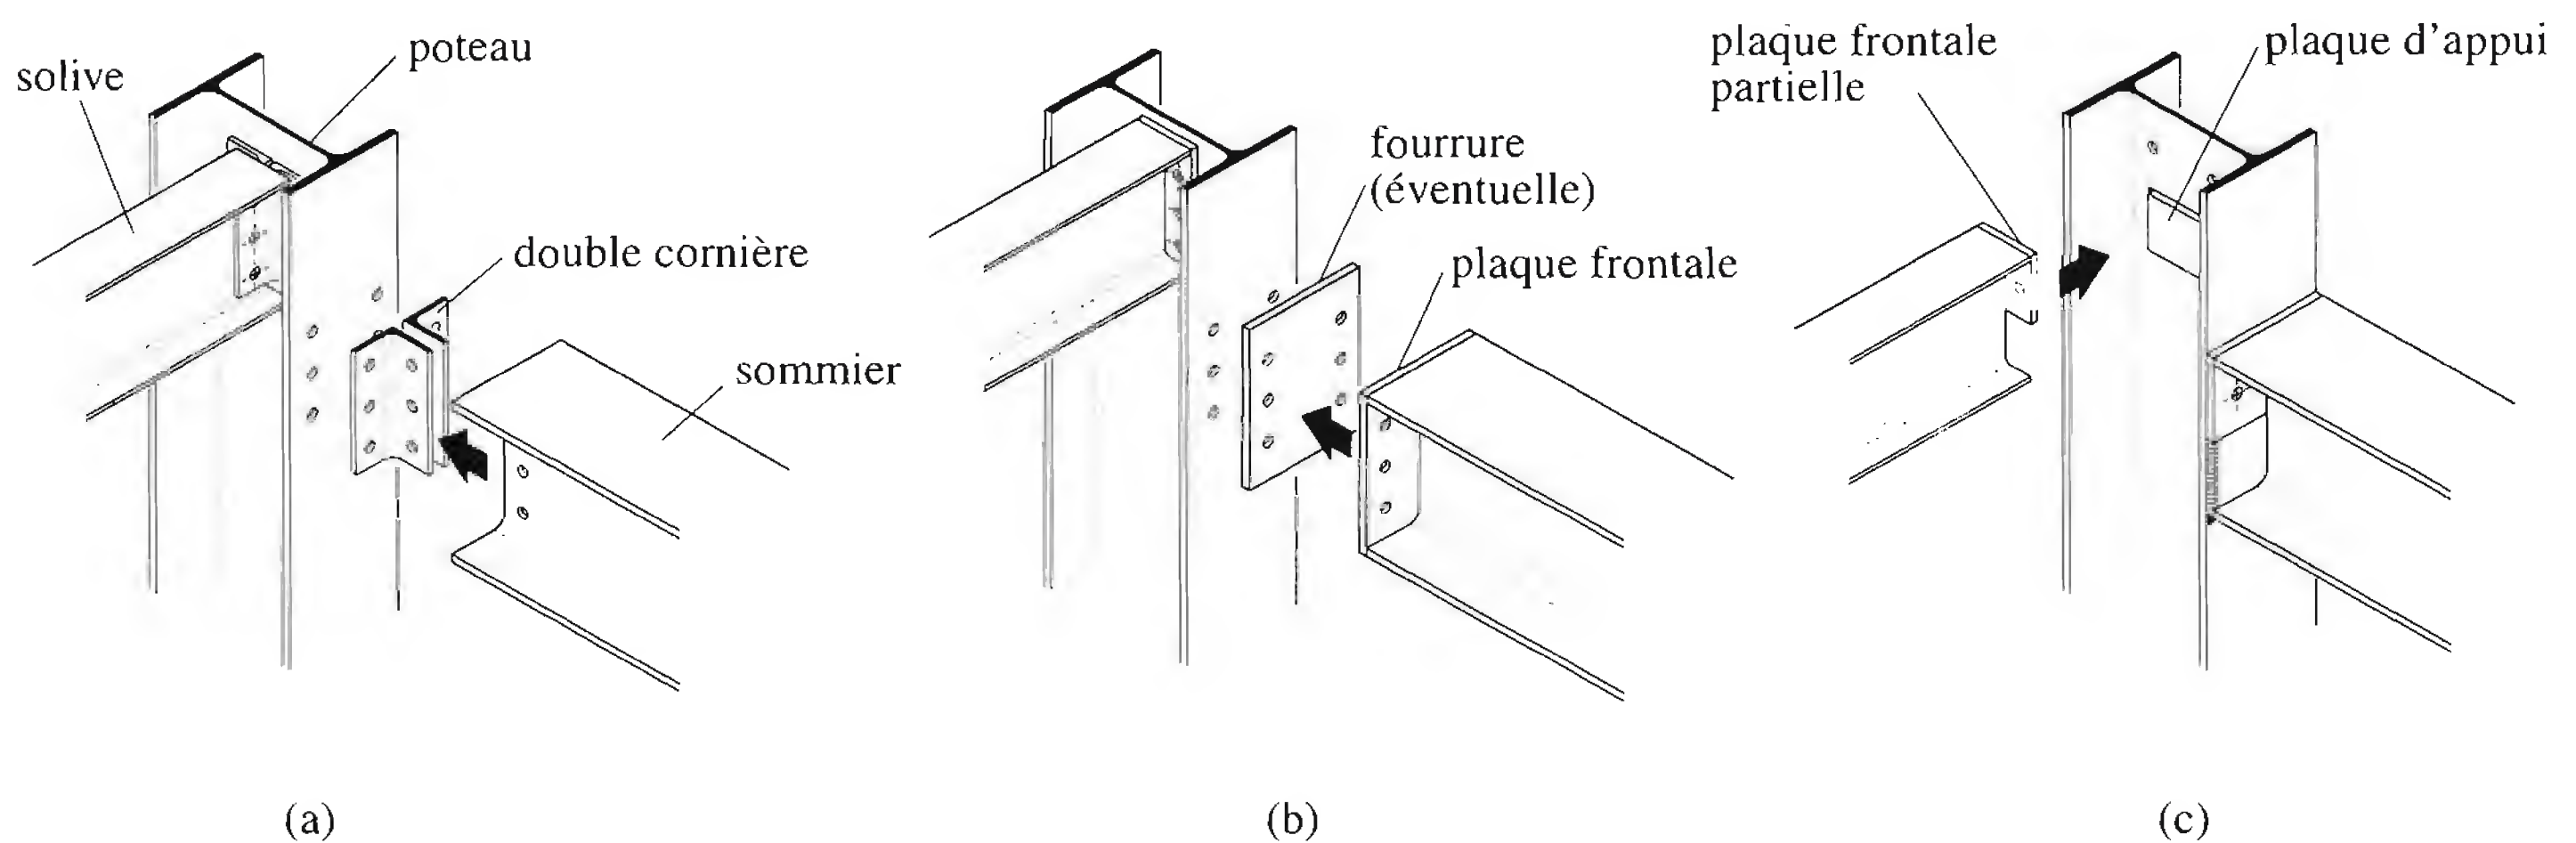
Assemblages articulés usuels poutre-poteau.
